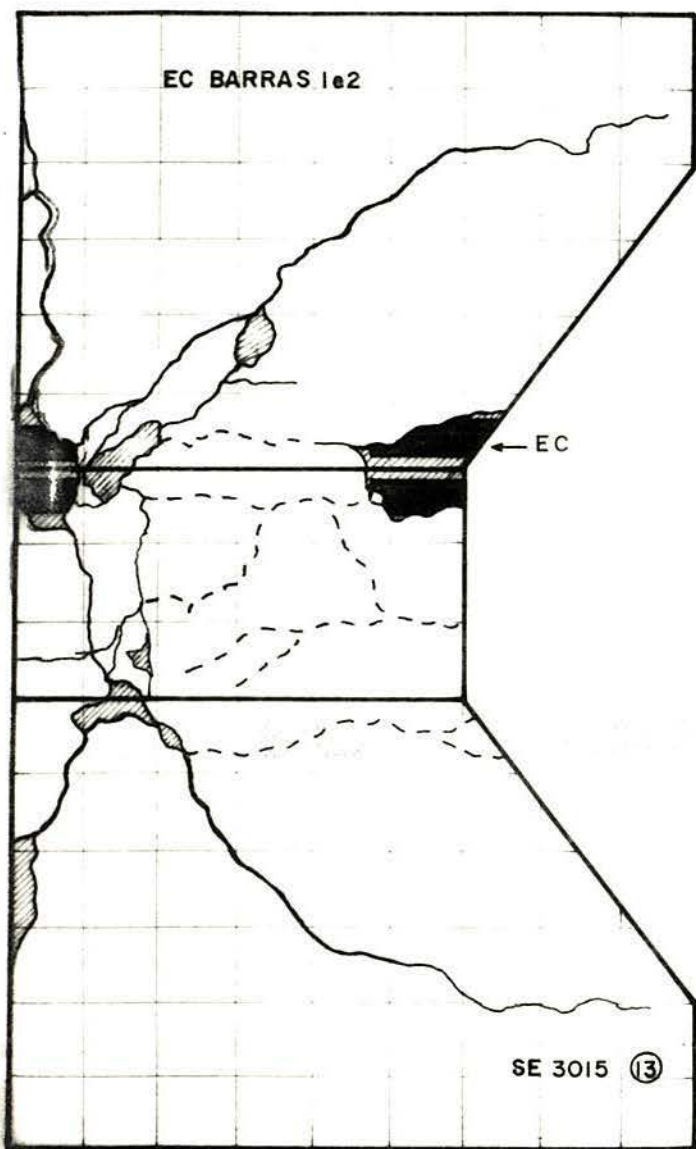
Fissuração dos CP SE 3015
